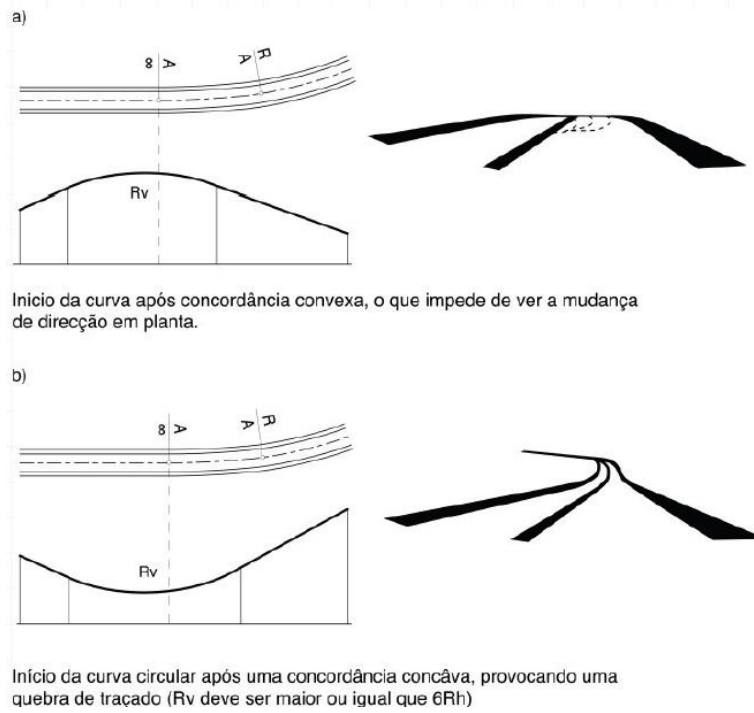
Coordenação do Traçado em Planta e Perfil 3 (Fonte: fig. 12C, [18] ou [19])
